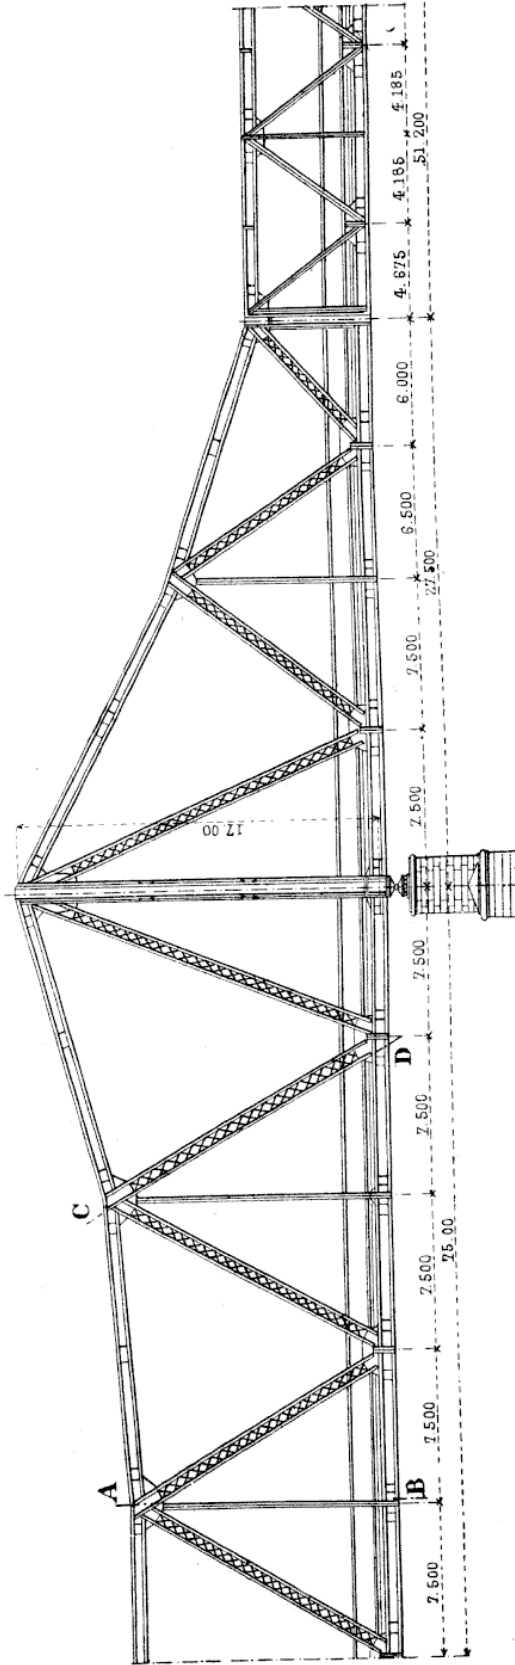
PONT DOUMER (Élévation longitudinale des poutres principales).
